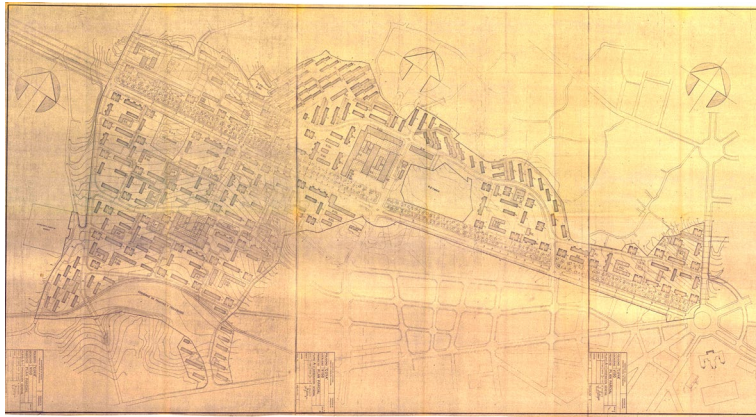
Plano del Plan Parcial de Coia de 1963.
